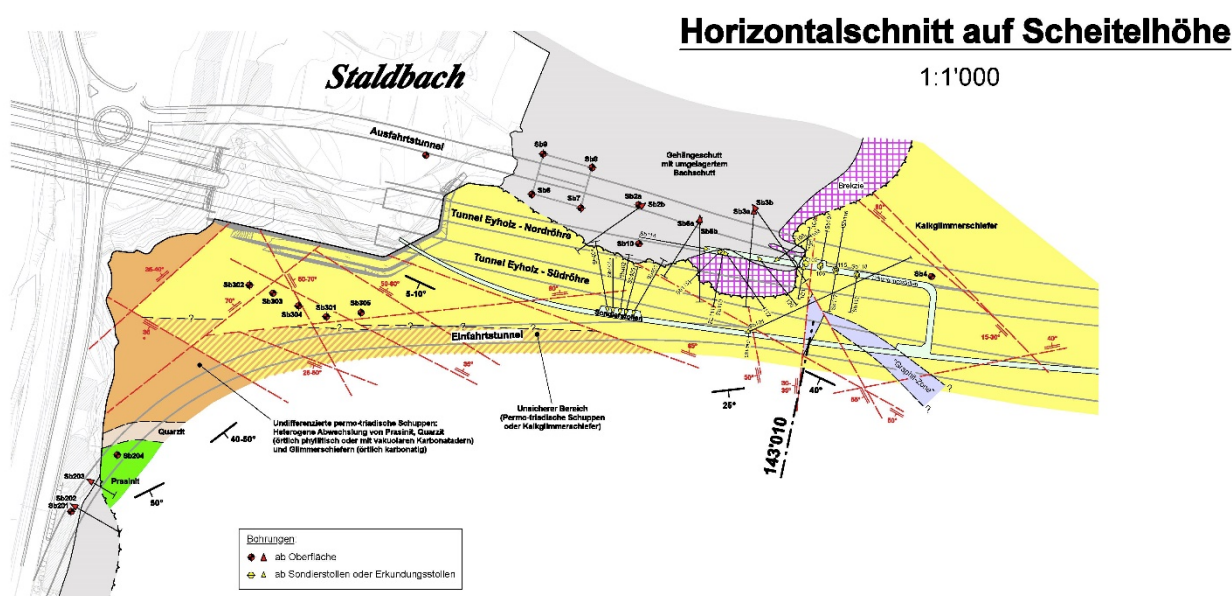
Tunnel d'Eyholz : coupe géologique horizontale à la hauteur du portail Ouest (Staldbach).
